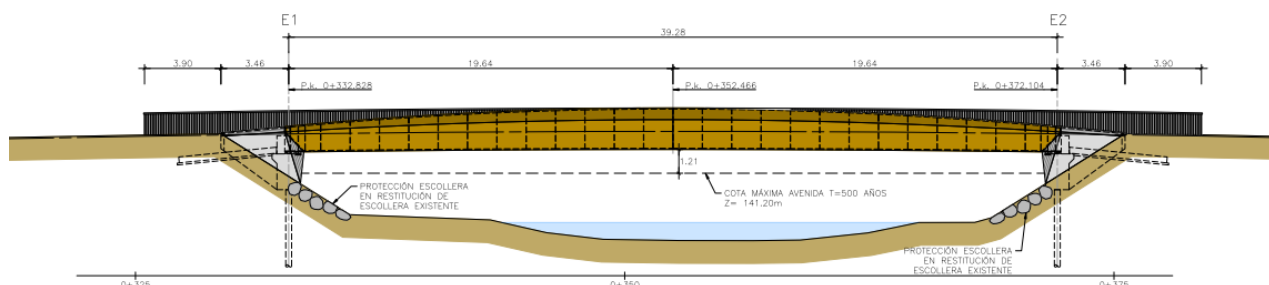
Alzado del nuevo puente sobre el río Pisueña.
